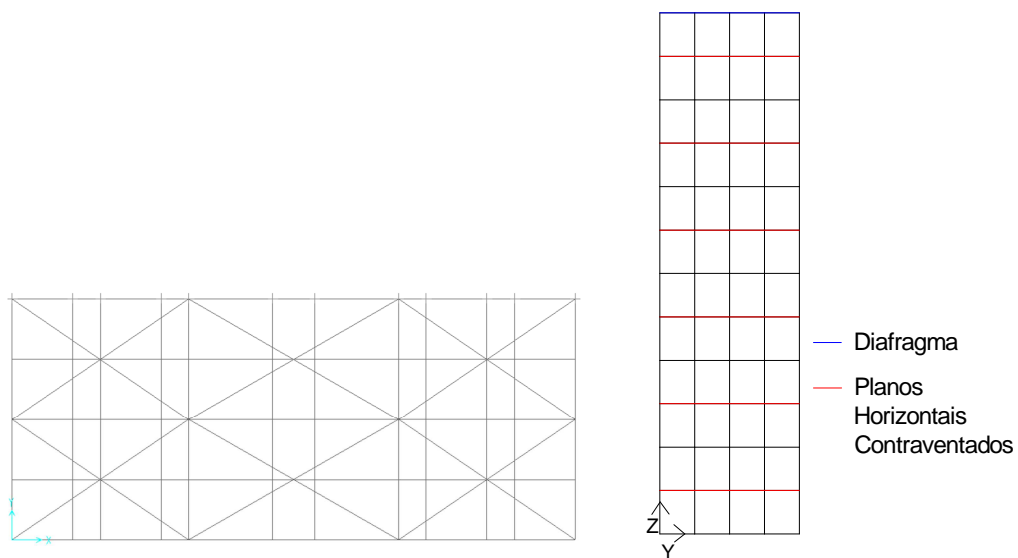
Configuração dos Planos de Contraventamento Horizontal Com Elementos de Contraventamento Grandes
